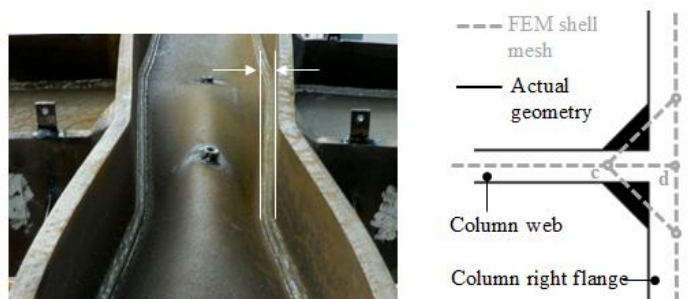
Modelação da zona de transição entre a alma e o banzo do pilar [Jordão, 2008].
